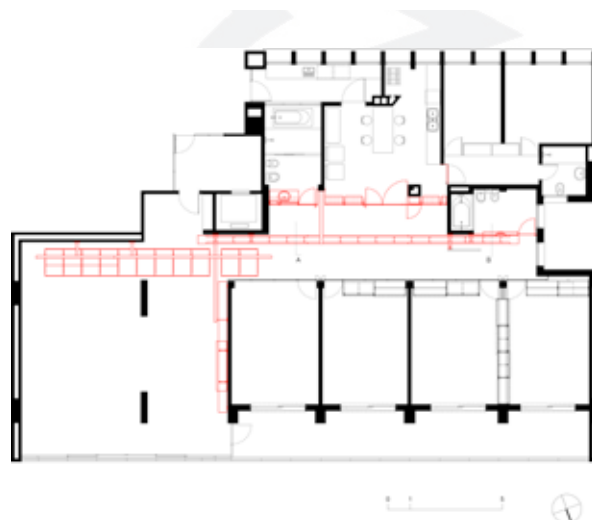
e Imagem 4 - planta. Reforma Prudência Andrade Morettin. © Nelson Kon
